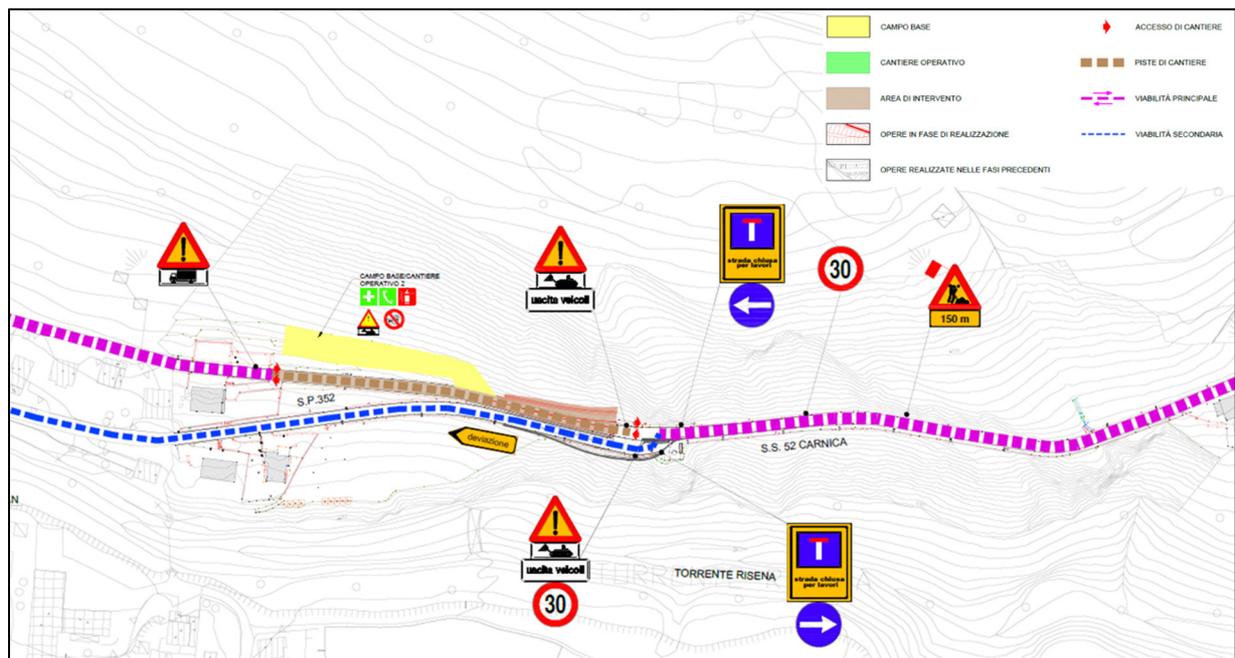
Cantierizzazione Fase 2 – Estratto elab. T00CA00CANPL01A
